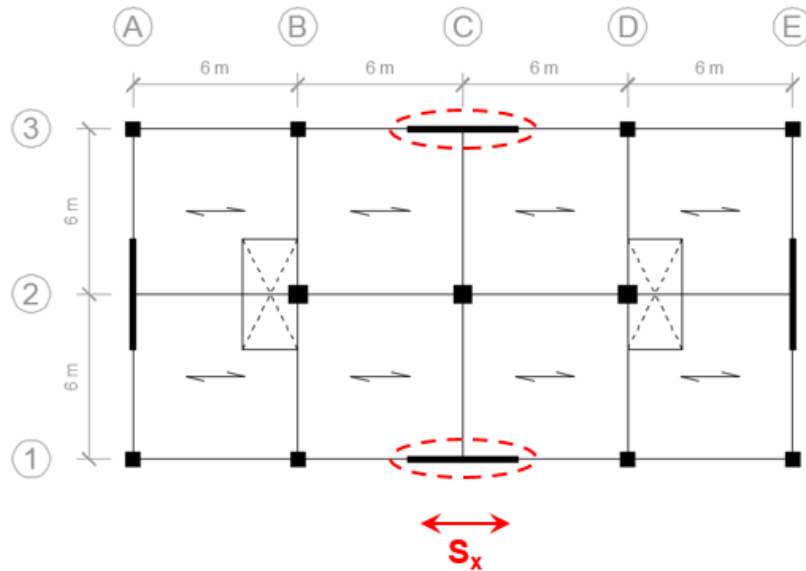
Ubicación de la conexión losa - muro estructural, para la fuerza sísmica en la dirección X
